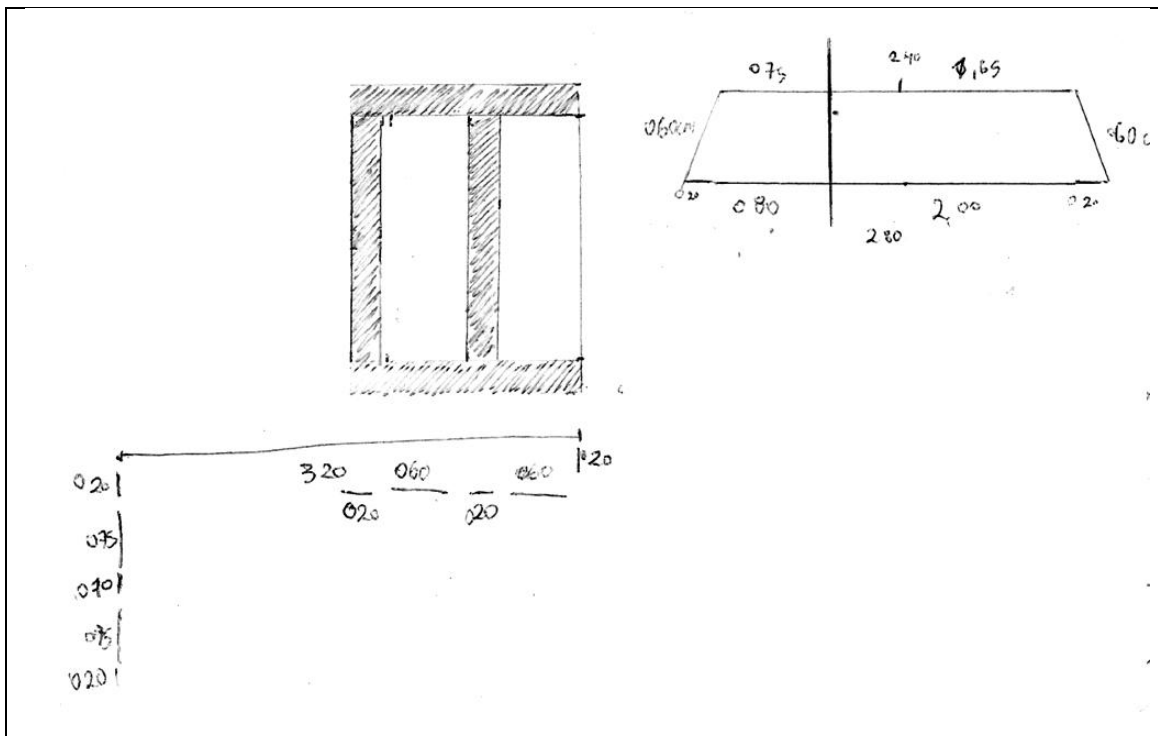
plano bloque estrecho 1 y2; plano falso techo.
